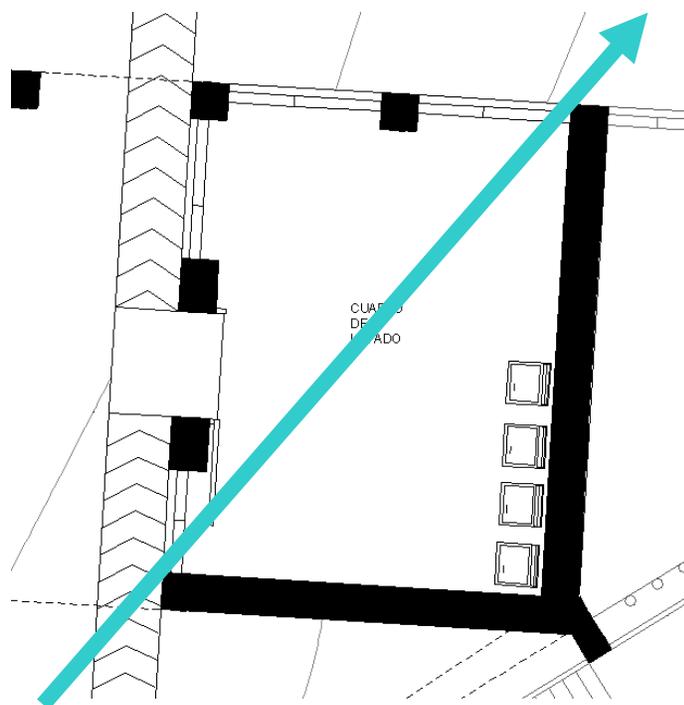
Lavandería en parte inferior de gimnasio. Flechas indican dirección de viento.
